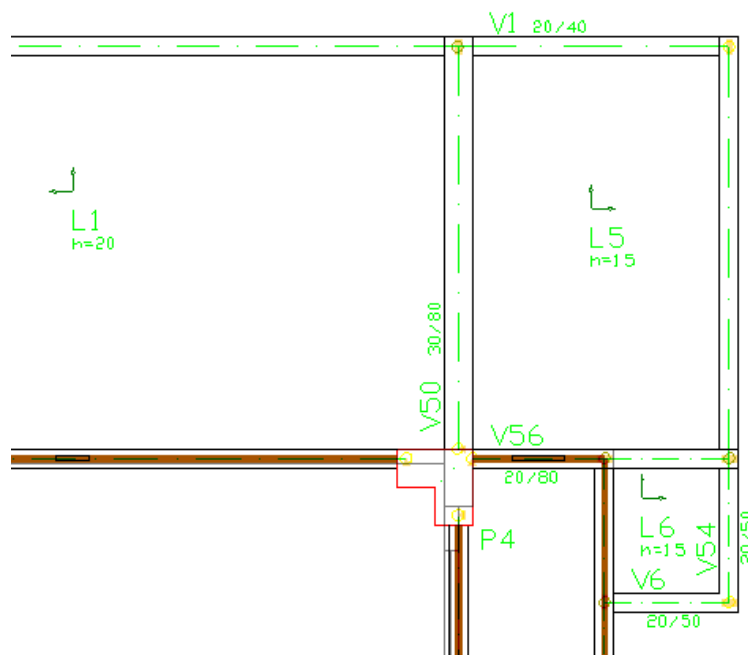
Pavimento PT1 da Solução Convencional com vigas de borda de menor seção e lajes de menor espessuras
